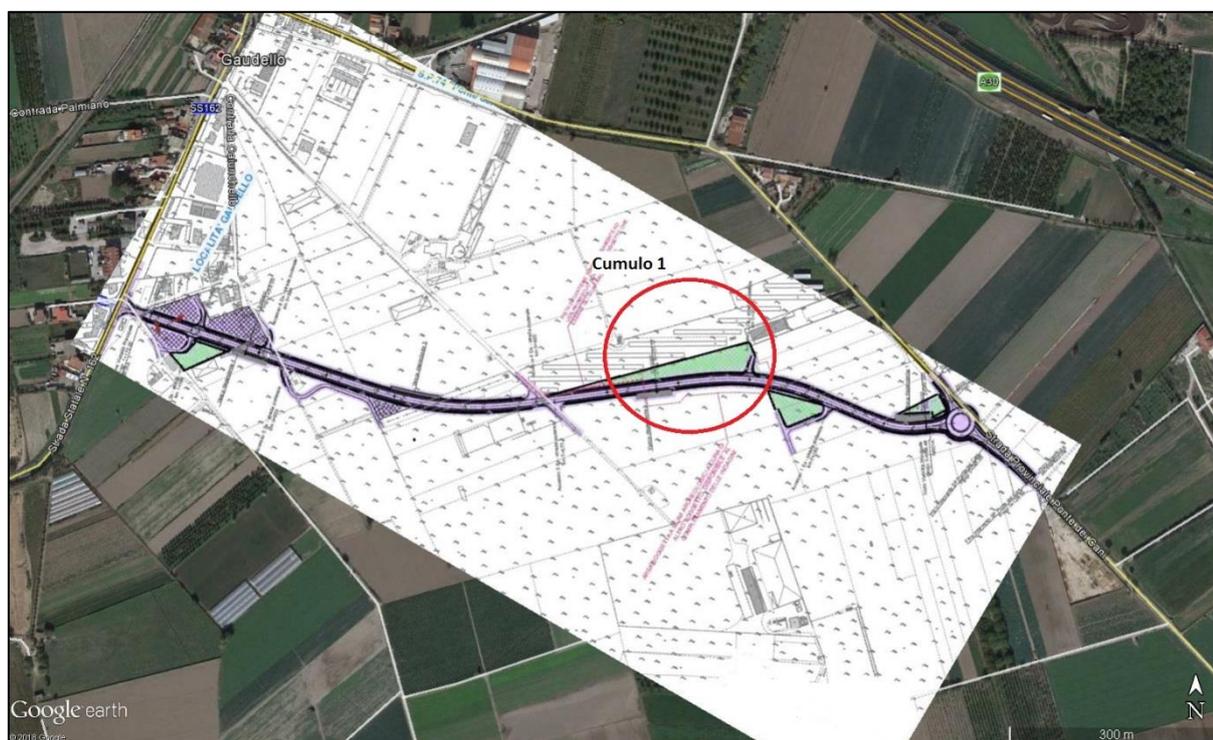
Immagini satellitari dell'area di studio con planimetria dell'area di cantiere
